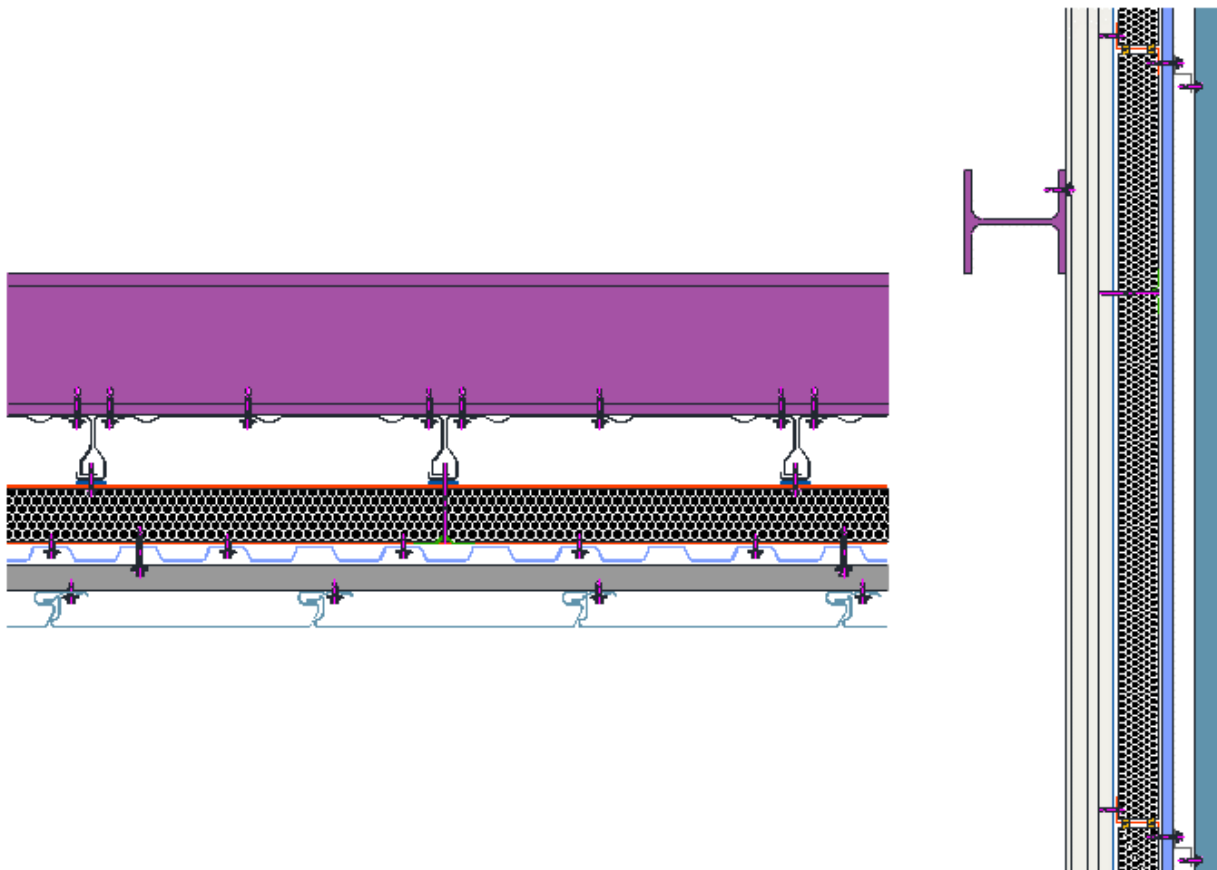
Coupe horizontale et verticale (exemple : plateaux verticaux 1^{er} écarteur horizontal, peau d'étanchéité verticale, 2^{ème} écarteur horizontal et peau extérieure verticale).
